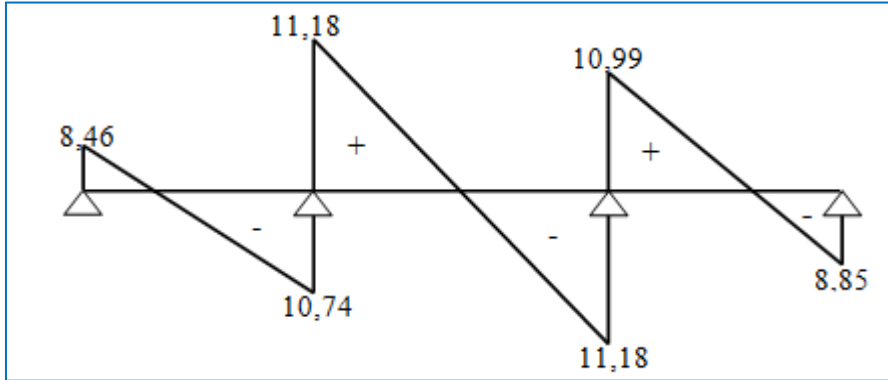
Diagramme des efforts tranchants en ELU (poutrelle type 01 – plancher terrasse)
